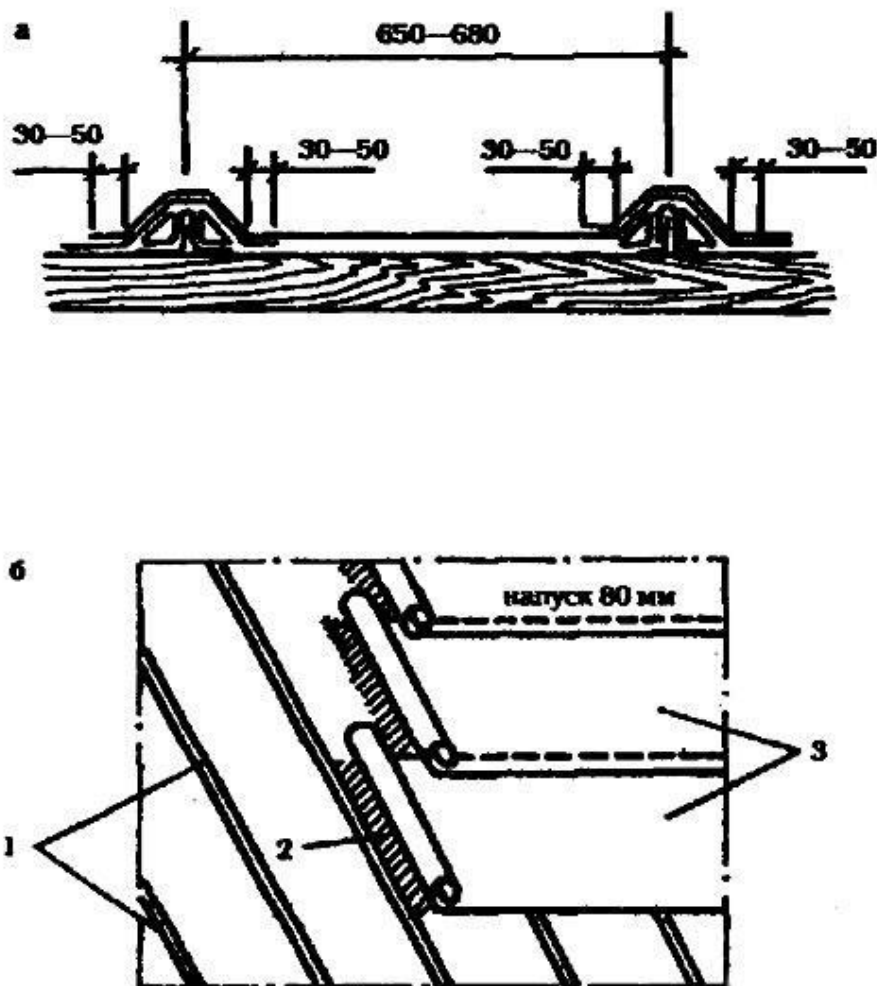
Покрытие стальных кровель рулонными материалами:
